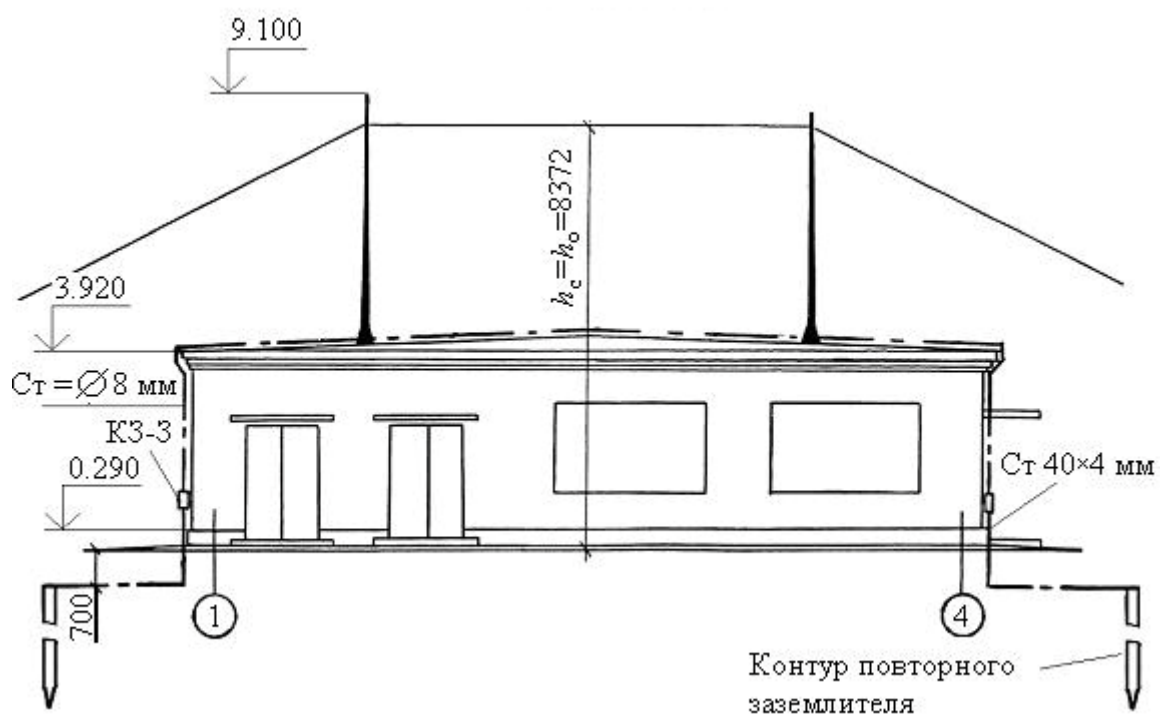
Молниезащита здания насосной (фасад по оси А)
